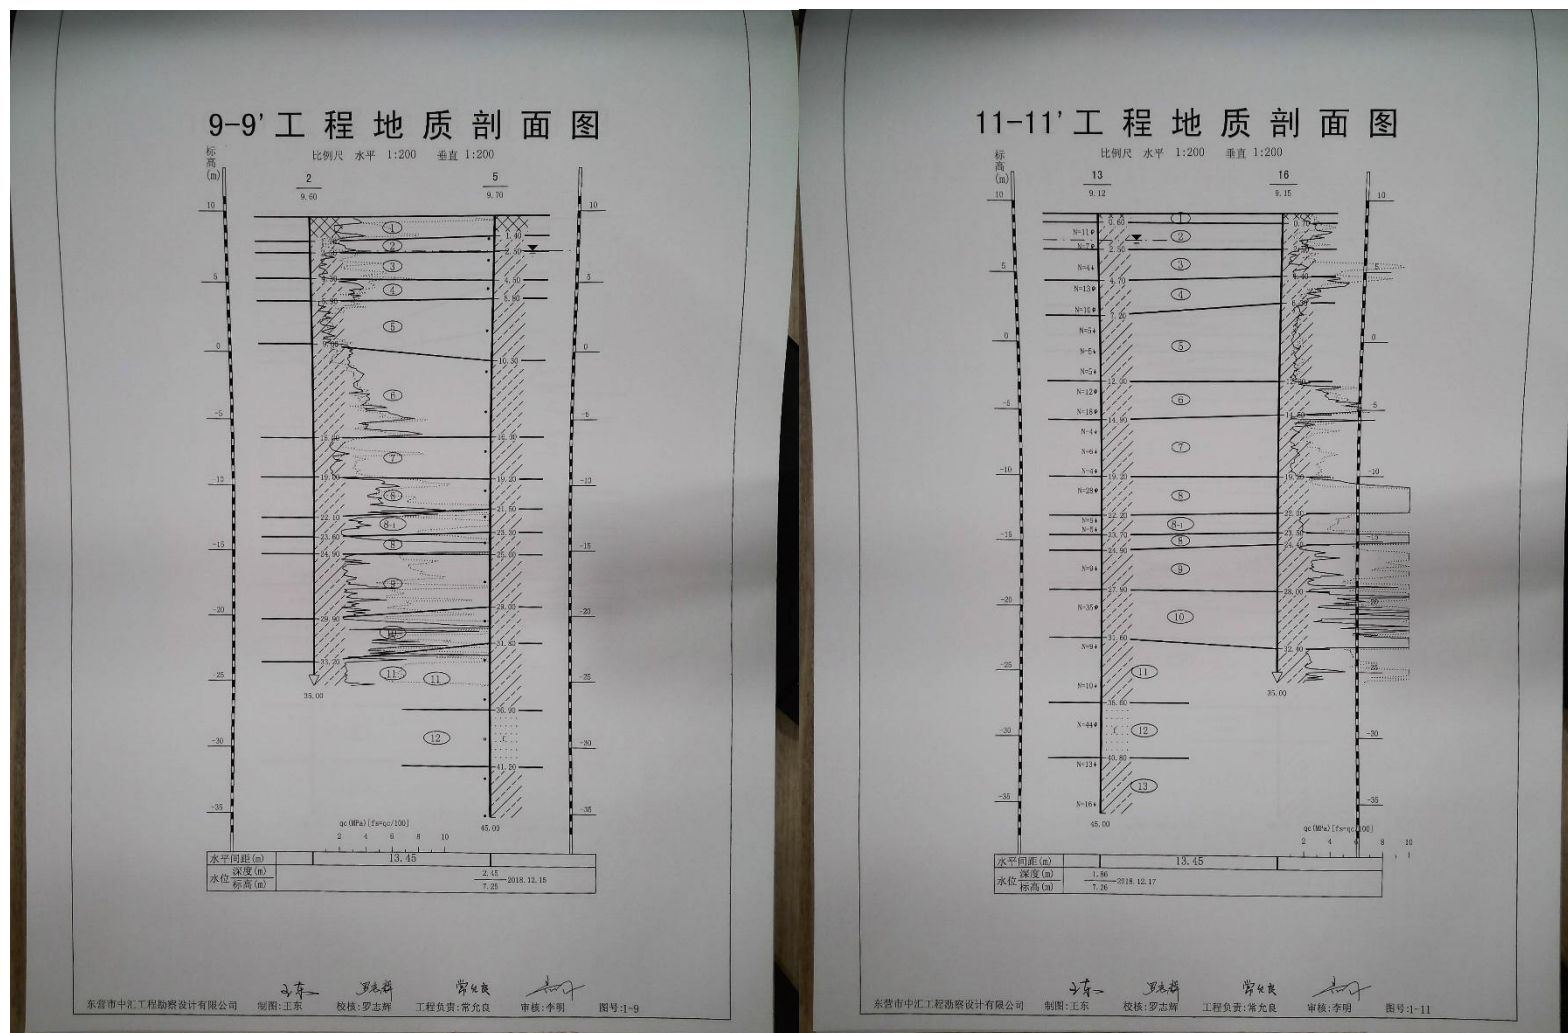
9-9'和 11-11' 工程地质剖面图
